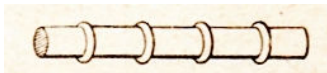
Barras Habrich (PIANCA, 1955, p. 393).
